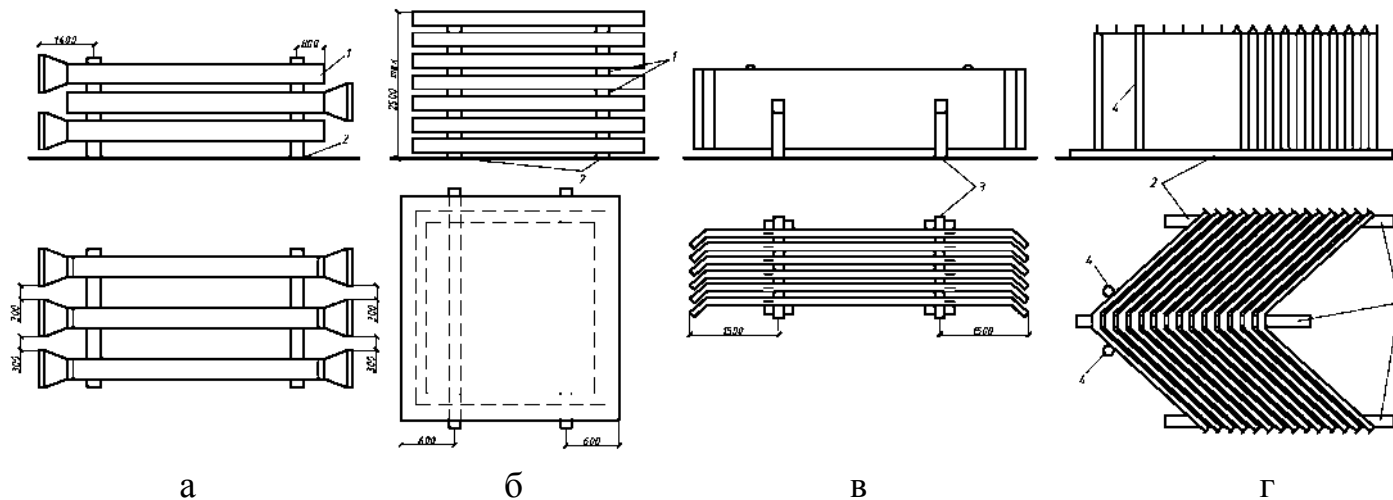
Схеми складування збірних конструкцій:
